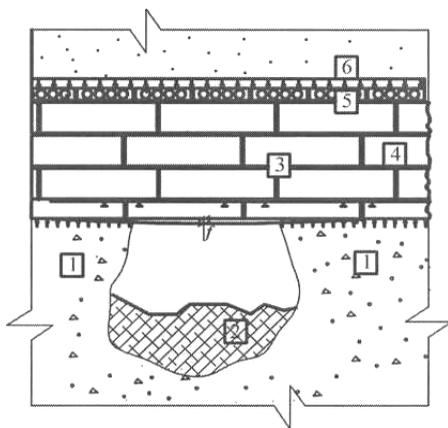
Схема сборного ленточного армированного фундамента над карстовым провалом:
